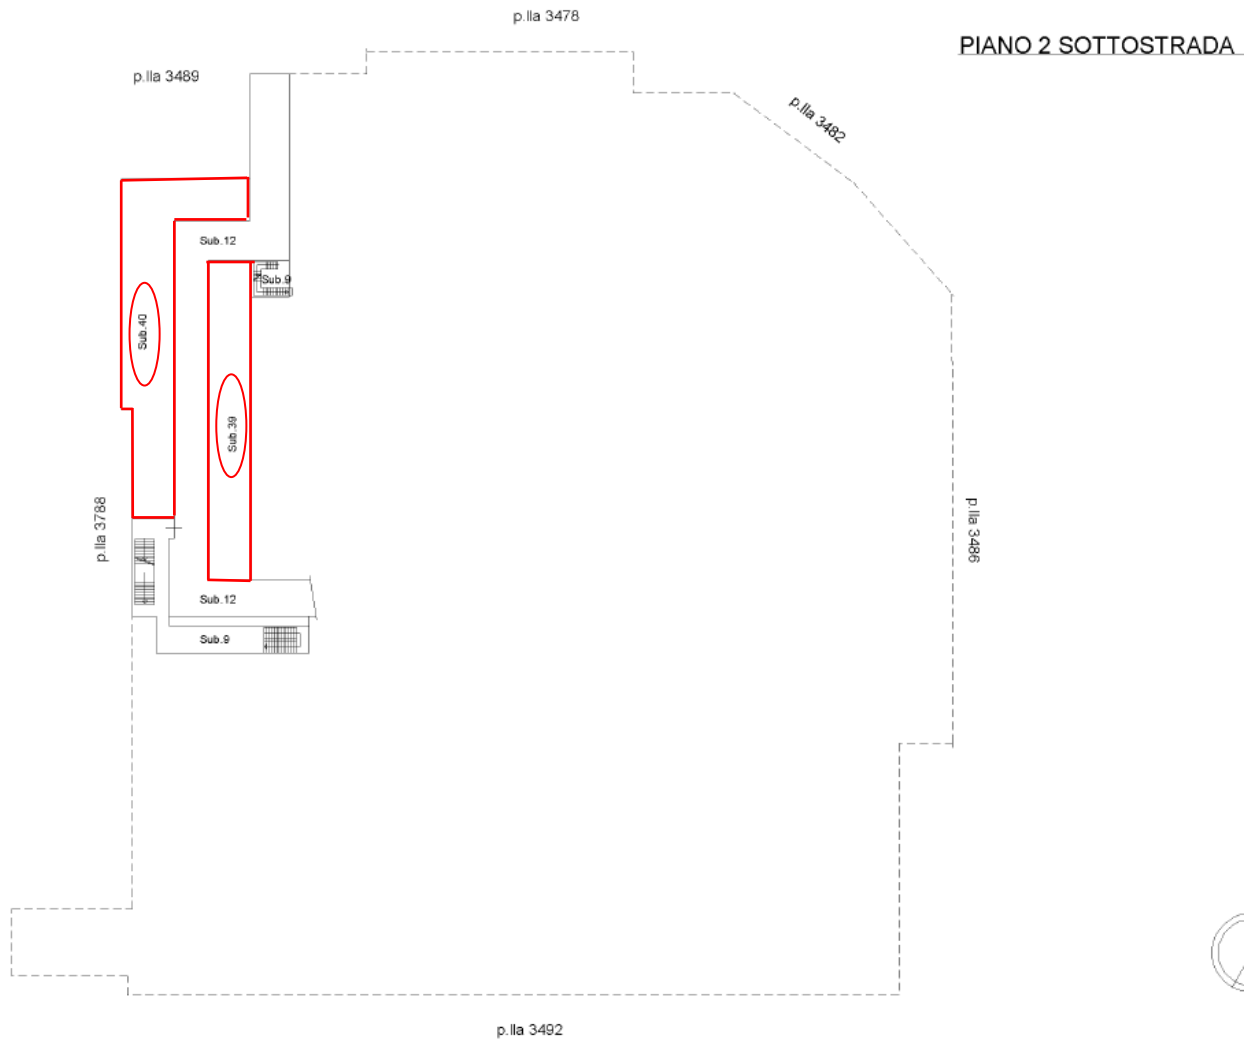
Individuazione dei subalterni (39 e 40) nell'elaborato planimetrico (piano S2)
